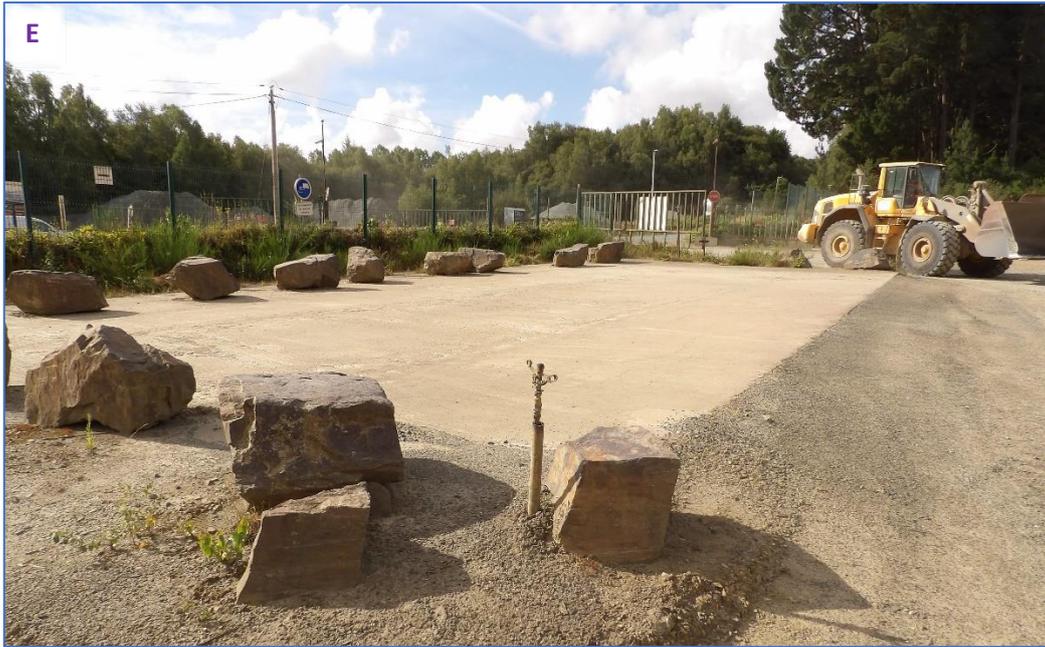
Aire étanche (et dispositif pour l'aspersion des pistes au premier plan)
